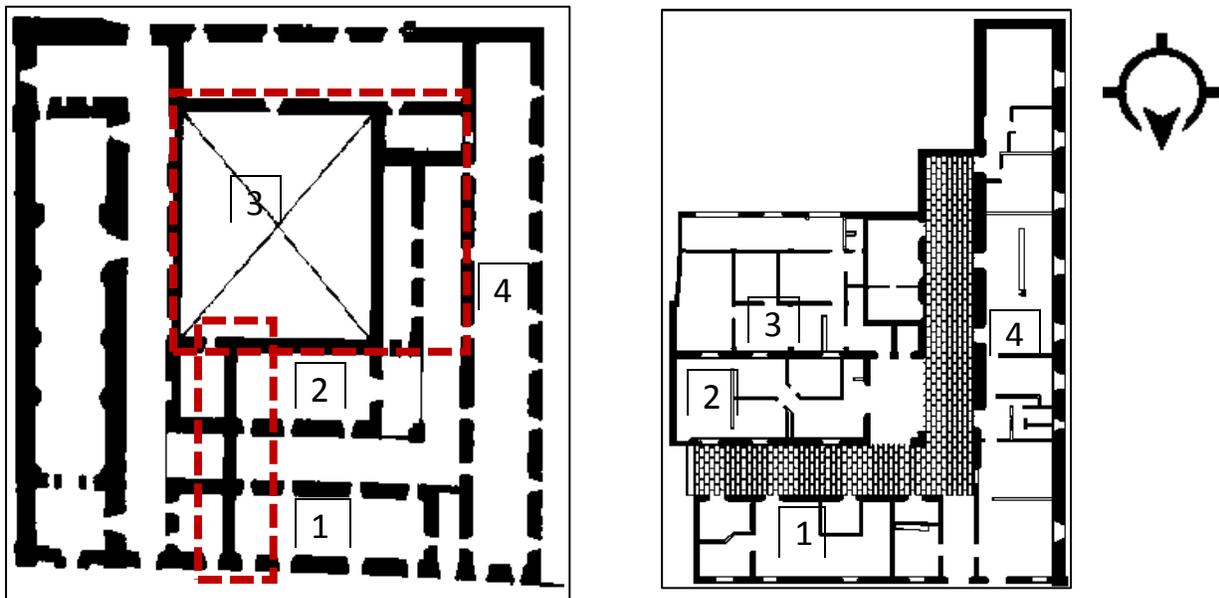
Numeración comparativa de planta arquitectónica 1766 con 2020
